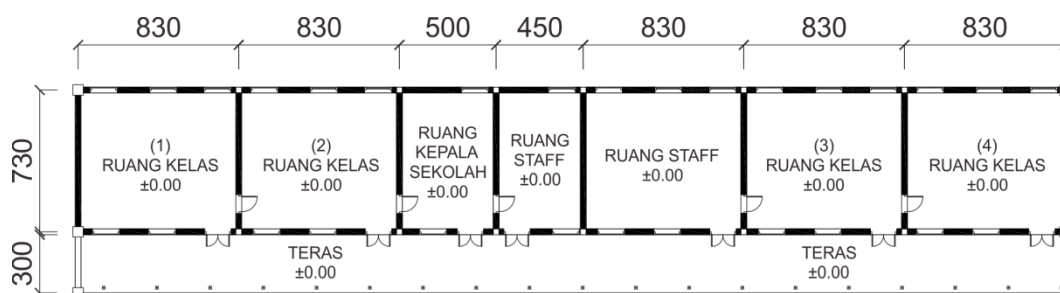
Massa Bangunan SMPN 3 Surabaya
